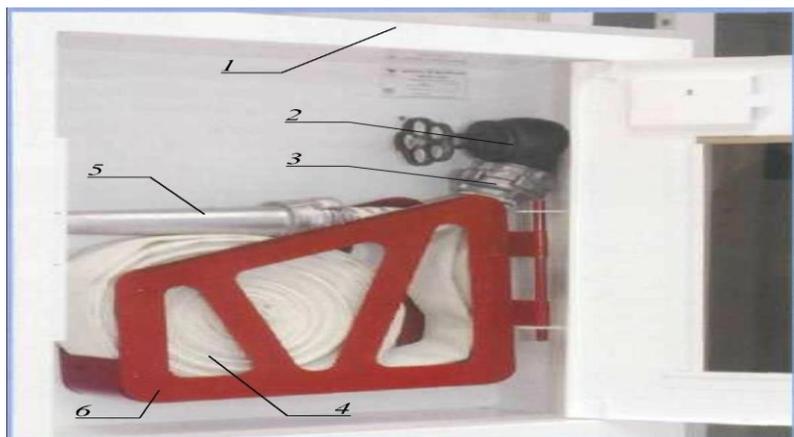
Общий вид пожарного крана. 1- корпус пожарного шкафа, 2- пожарный вентиль, 3- быстросмыкающаяся рот-гайка, 4- пожарный рукав, 5- пожарный ствол, 6- поворотная корзина
